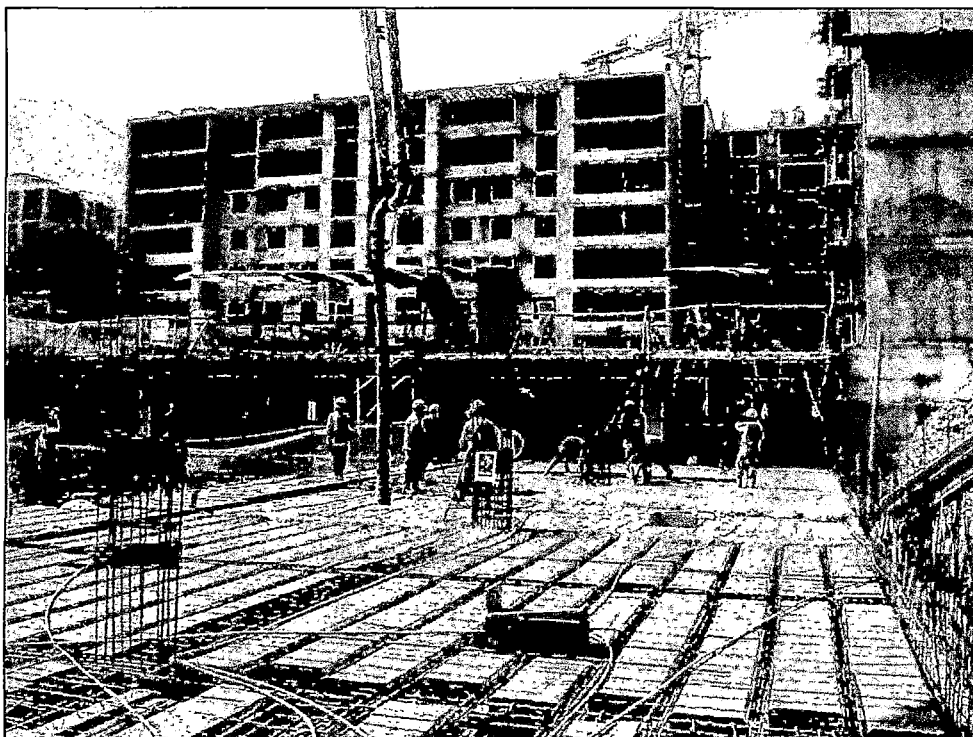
Losa de estacionamiento con viguetas prefabricadas
